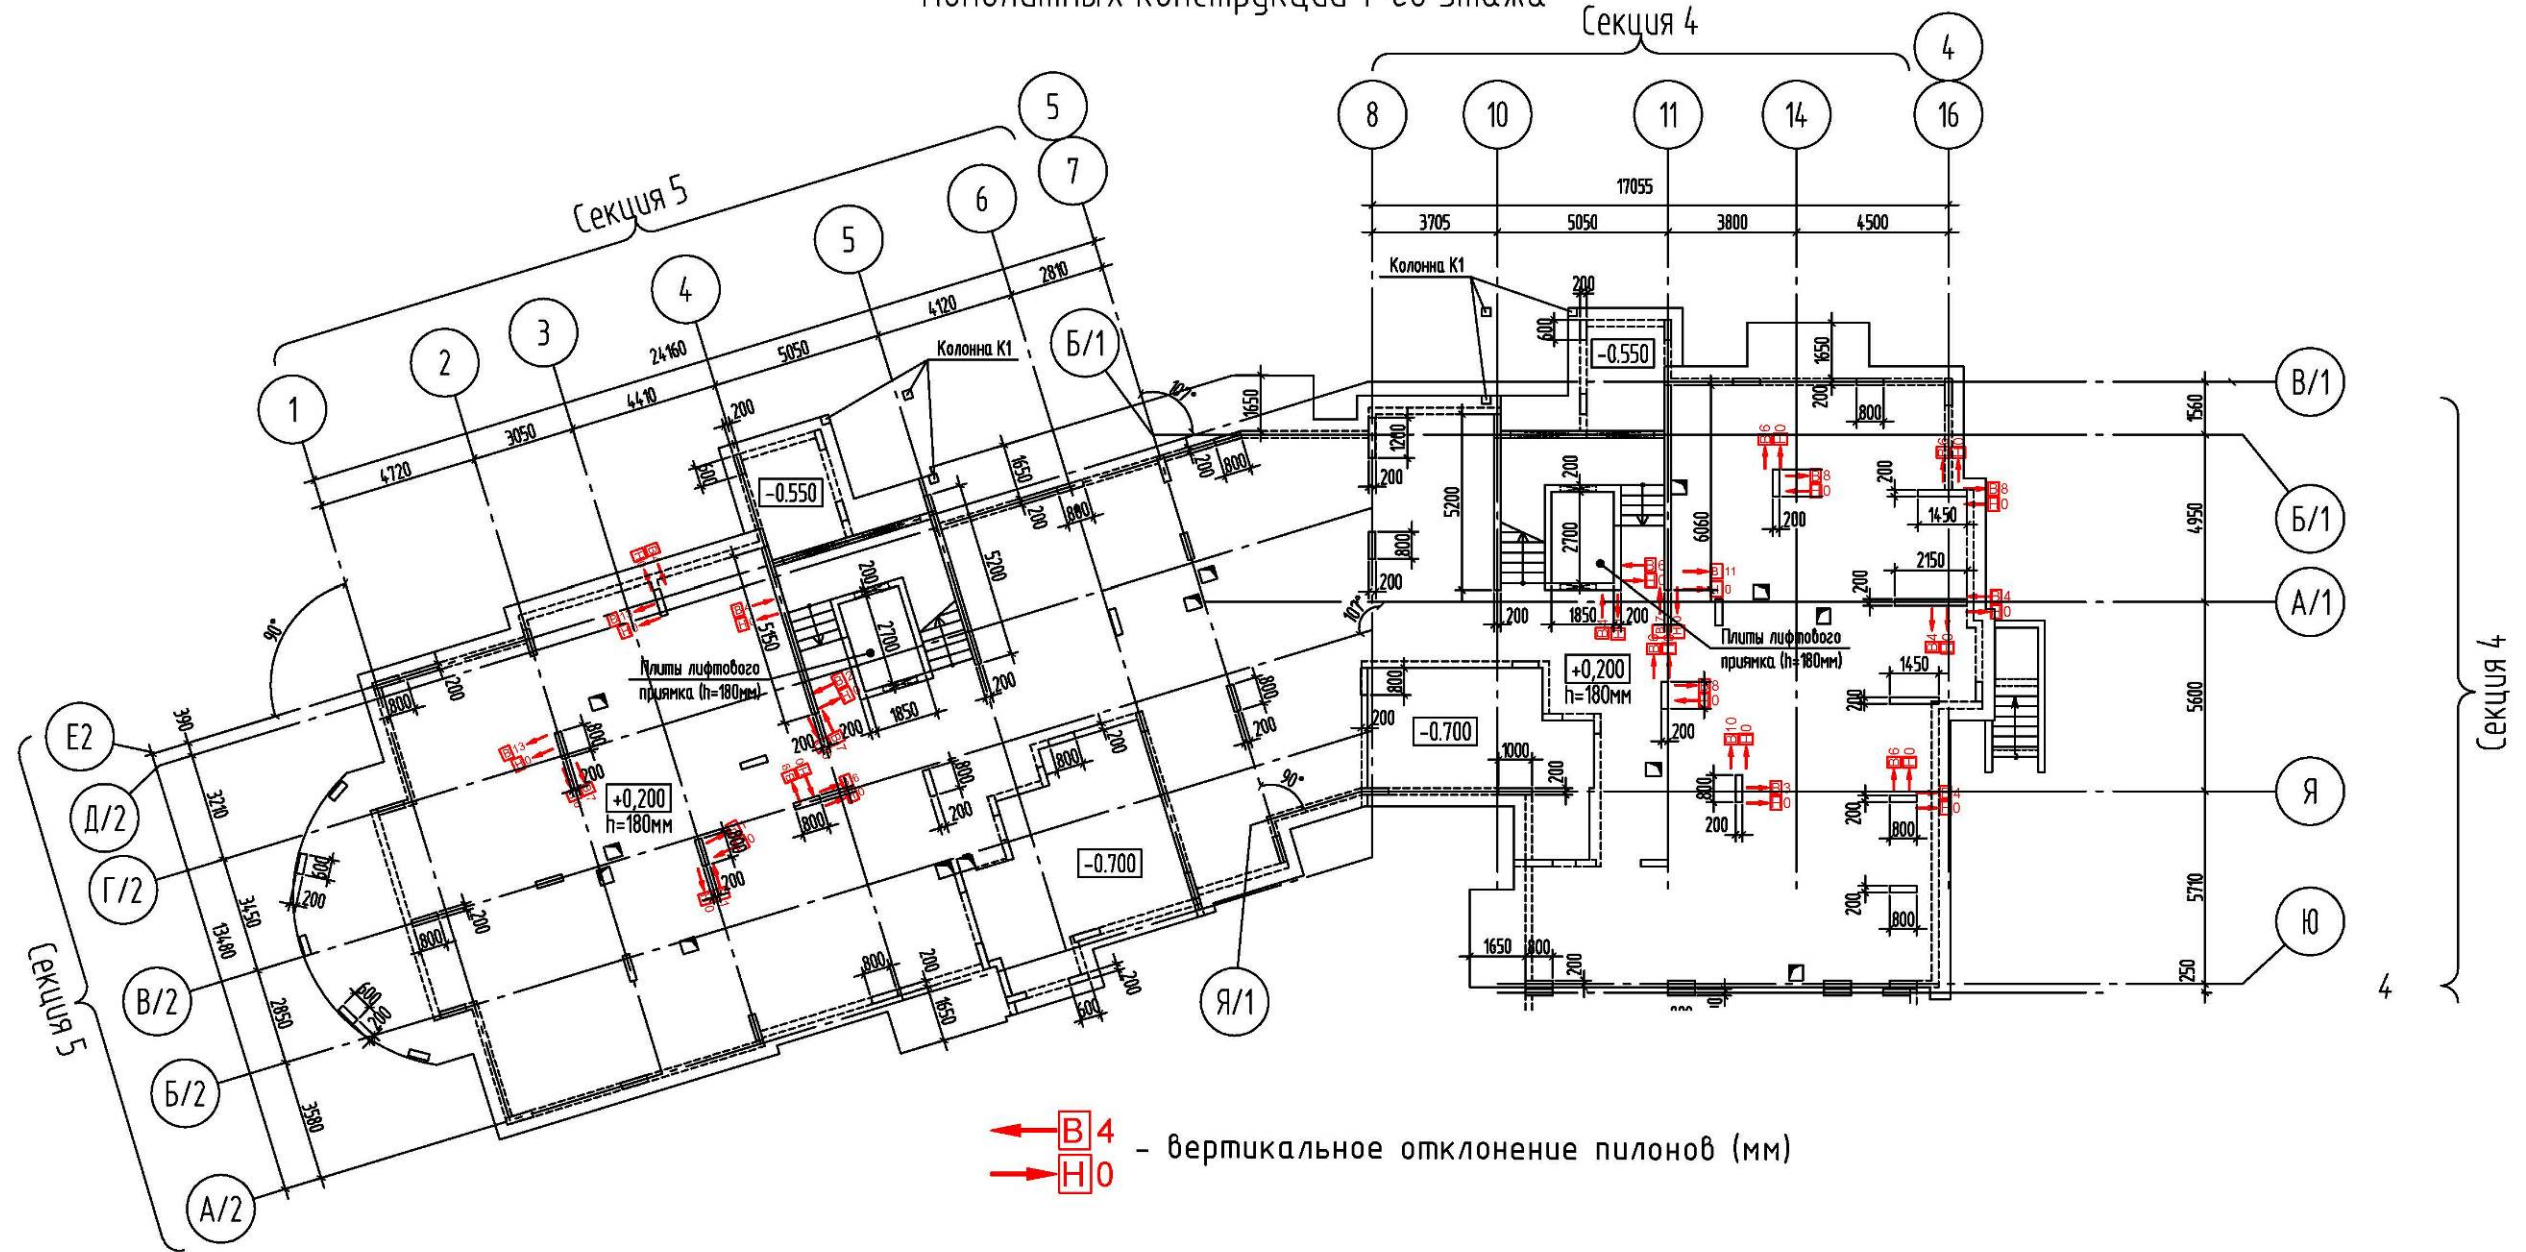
Отклонения от вертикали и горизонтали несущих монолитных железобетонных конструкций 1-го этажа
